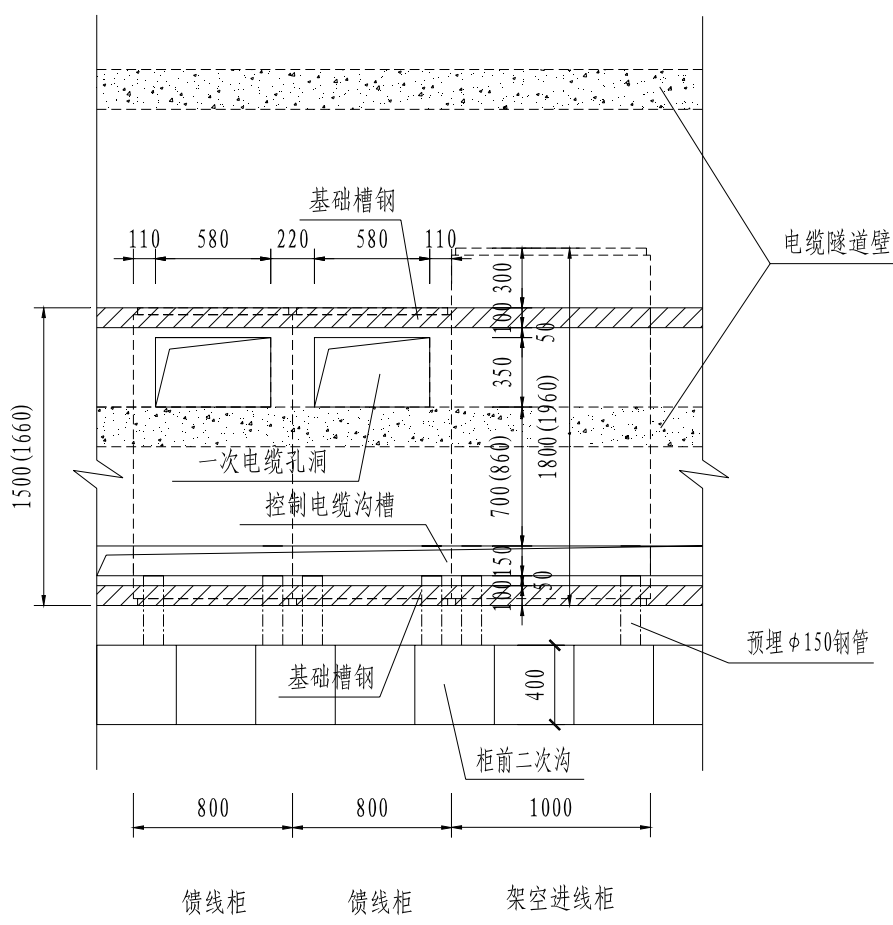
电缆沟道出线方式 12kV 开关柜基础埋件、 平面布置图
